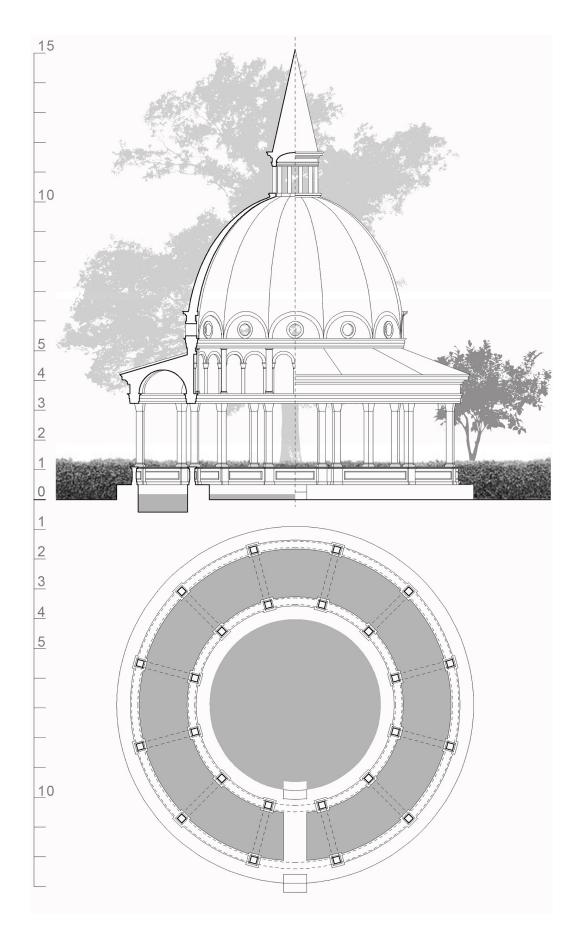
Ricostruzione del padiglione dalla sezione, in pianta, semi-sezione e semi-prospetto.
